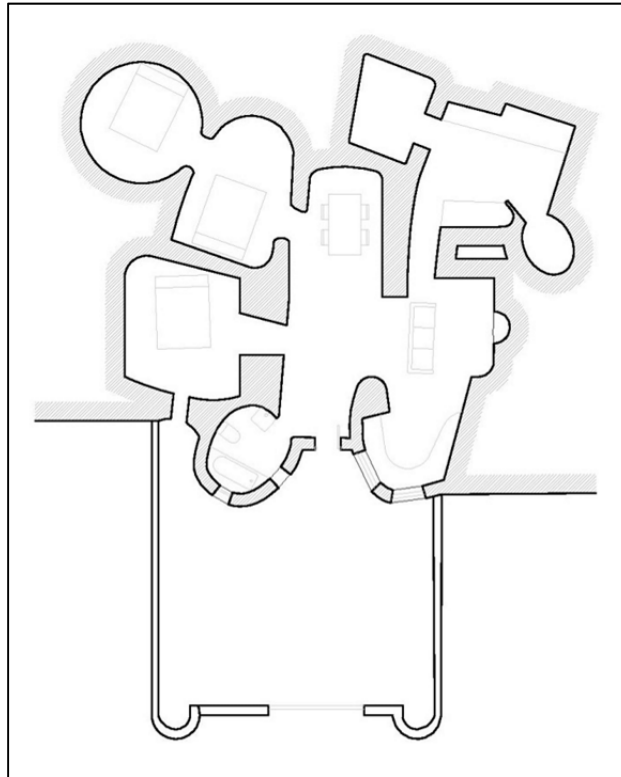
Planta casa-cueva nº8. Planta realizada por el arquitecto que la rehabilitó.
